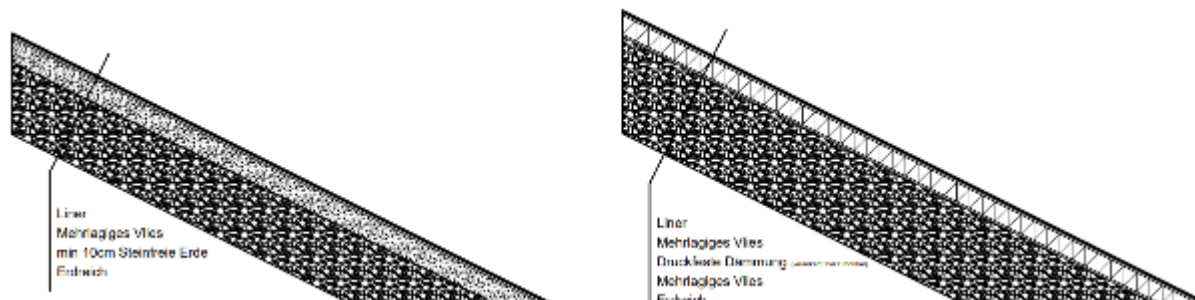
Mögliche Wandkonstruktionen mit den Hauptkomponenten ohne Wärmedämmung (links) und mit Wärmedämmung (rechts)
